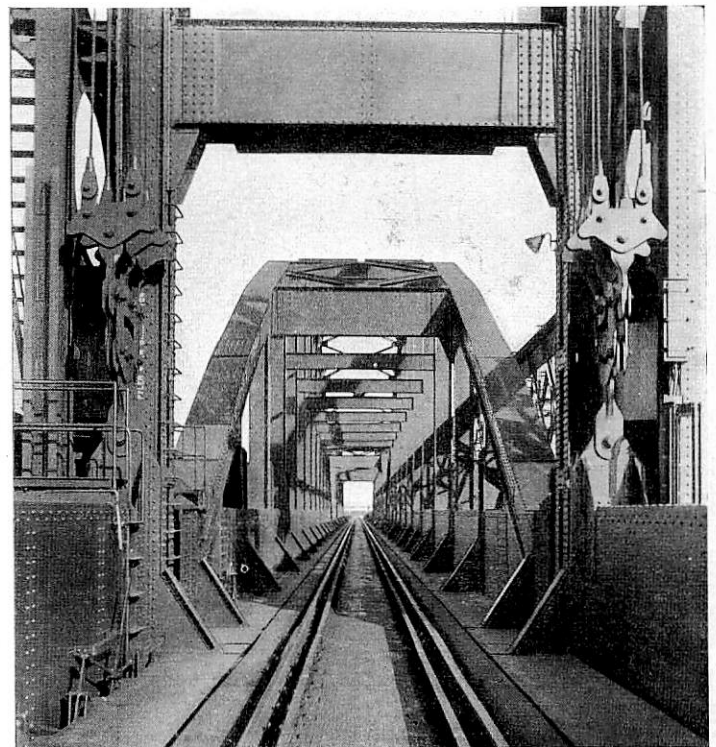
Gleichgewichtsregler der Hubbrücke und Innenansicht der Langerschen Balkenbrücken.
